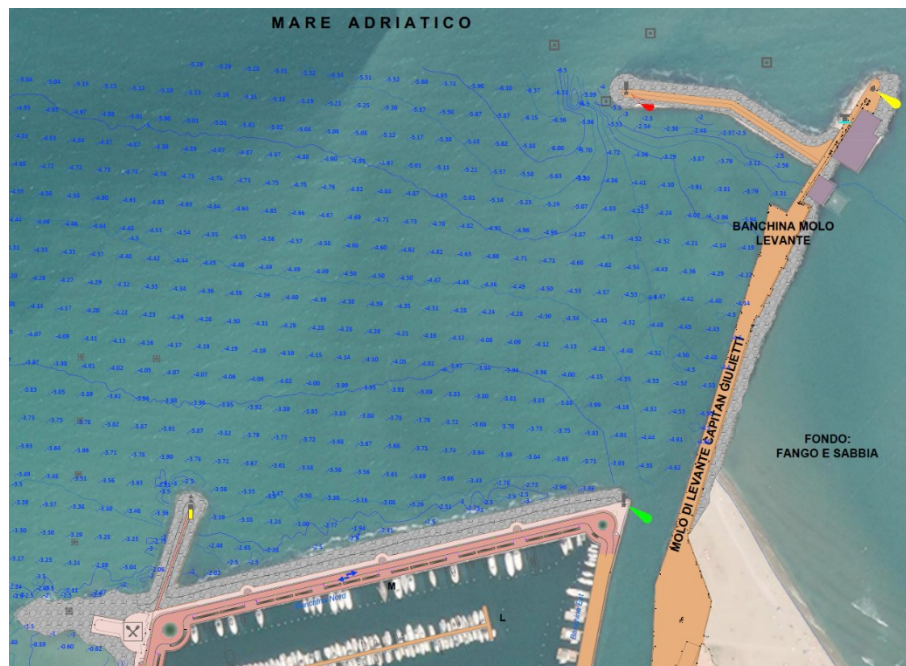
Profondità del fondale nella zona di espansione dell'avamposto (rilievo batimetrico Aprile 2021).
